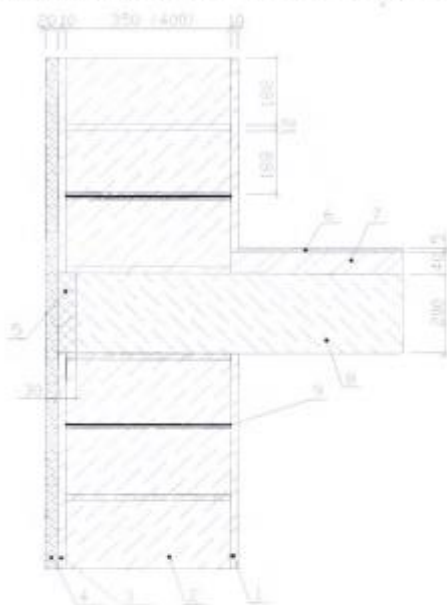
Вертикальное сечение по наружной стене:
